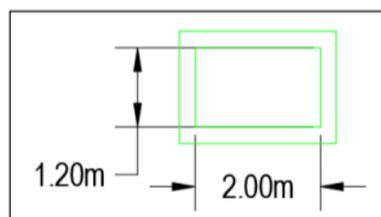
Sección propuesta para canal secundario hasta el empalme con el canal principal.
